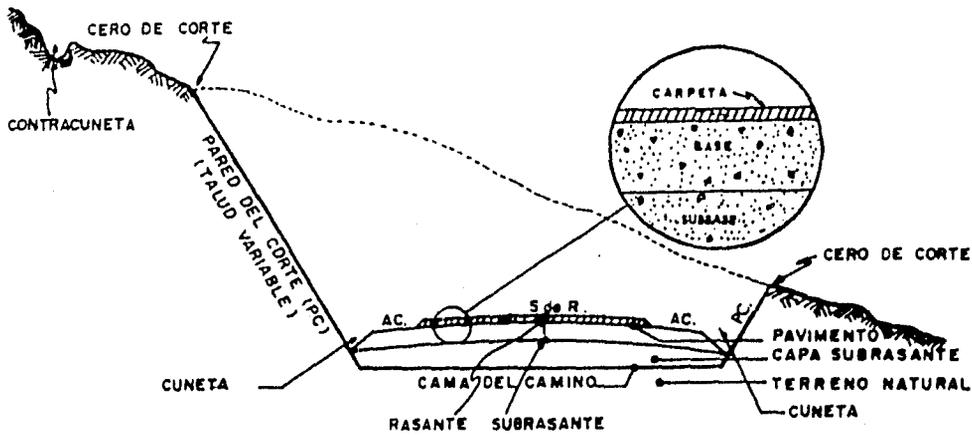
Sección transversal típica en corte, para carreteras de dos carriles; se muestra un detalle de pavimento flexible.
